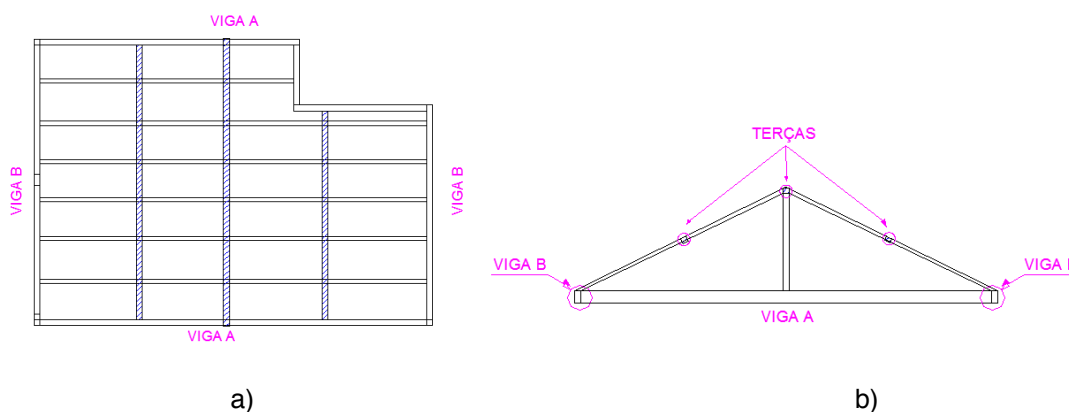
a) Planta de demonstração das vigas existentes, b) Corte frontal ilustrando o posicionamento das peças
